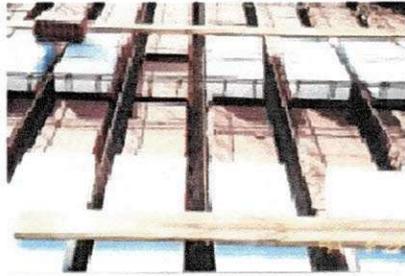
c e 7.2.3.d Laje nervurada formada por lajes pré-fabricadas com incorporação de blocos de isopor (cortesia lajes Anhanguera) e estrutura de cimbramento de alumínio (cortesia Peri)
